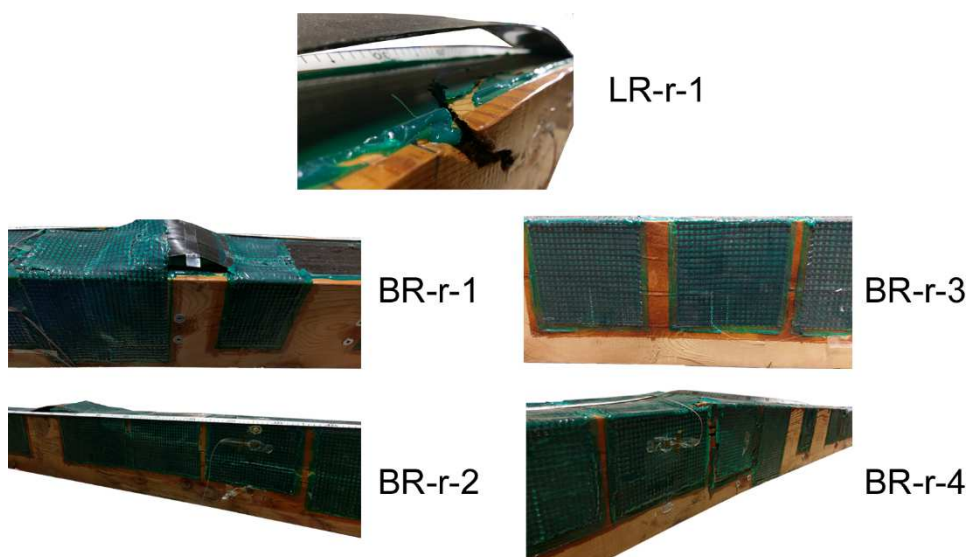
Imágenes de las roturas de las vigas reparadas de gran escuadría con rotura previa.
